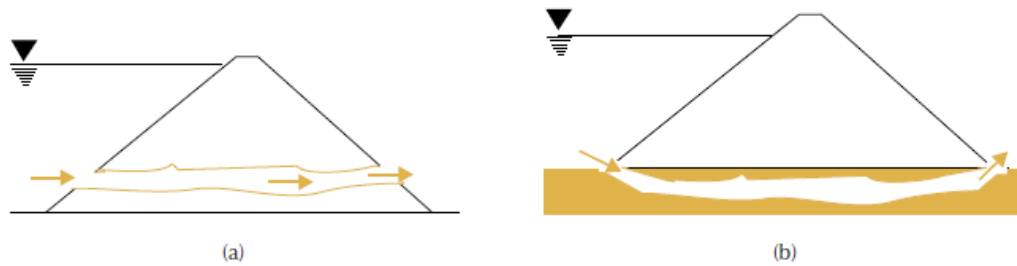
Renard dans le corps de l'ouvrage (a) ou dans la fondation (b)
